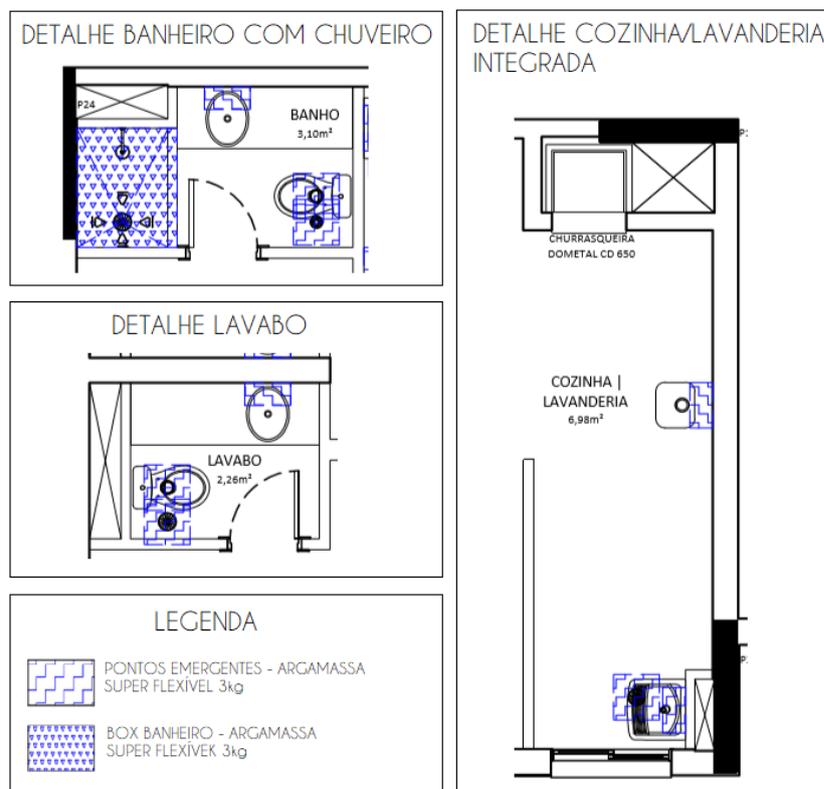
Detalhe de impermeabilização de box em parede de *drywall
